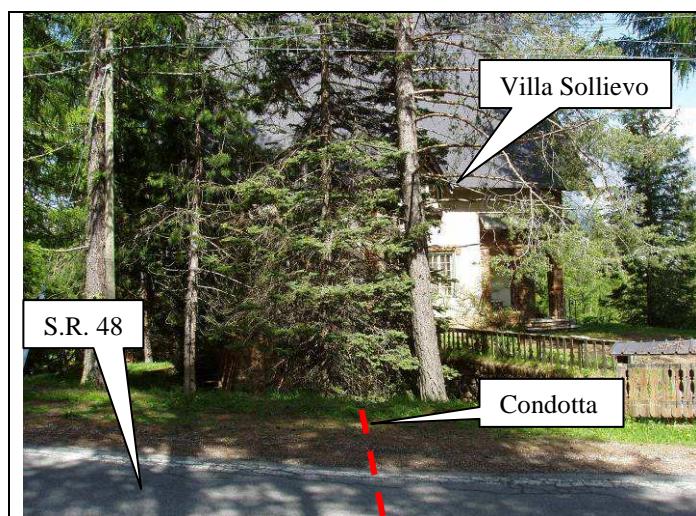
Condotta distribuzione – secondo attraversamento della S.R. 48
